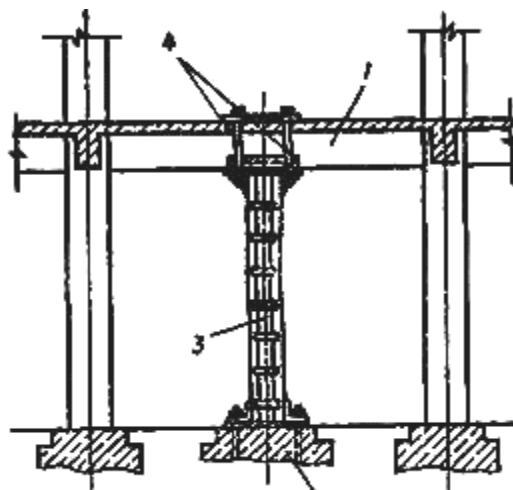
Усиление балки подведением жесткой опоры: 1 – усиливаемая балка; 2 – дополнительный фундамент; 3 – колонна усиления; 4 – болты
